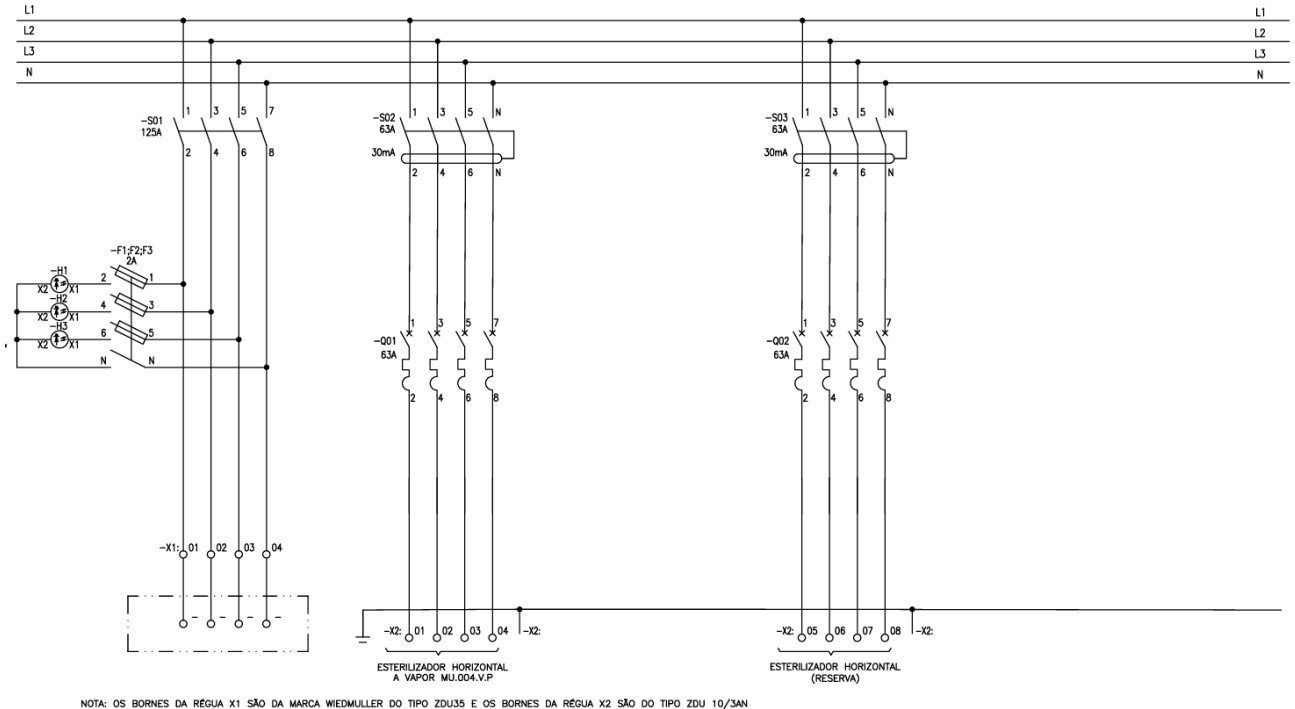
Esquema multifilar dos esterilizadores horizontais.
